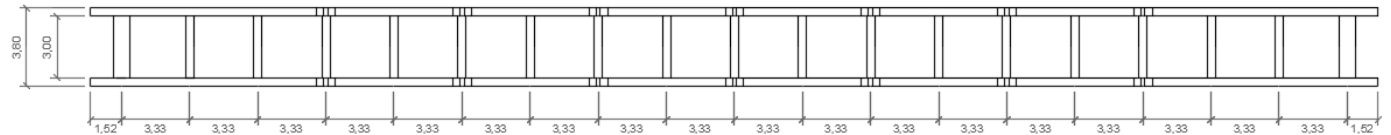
Dimensiones generales en planta de la pasarela (vigas longitudinales y vigas transversales)
